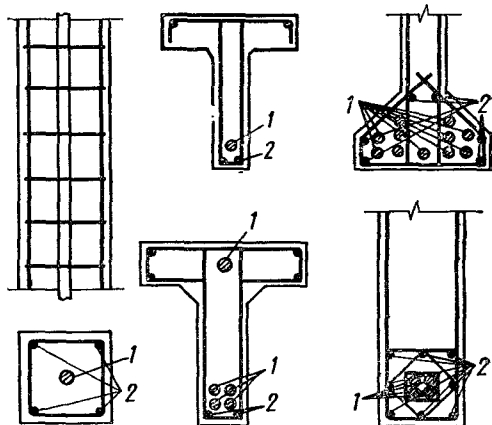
Схемы расположения арматуры в поперечном сечении предварительно напряженных железобетонных элементов:
